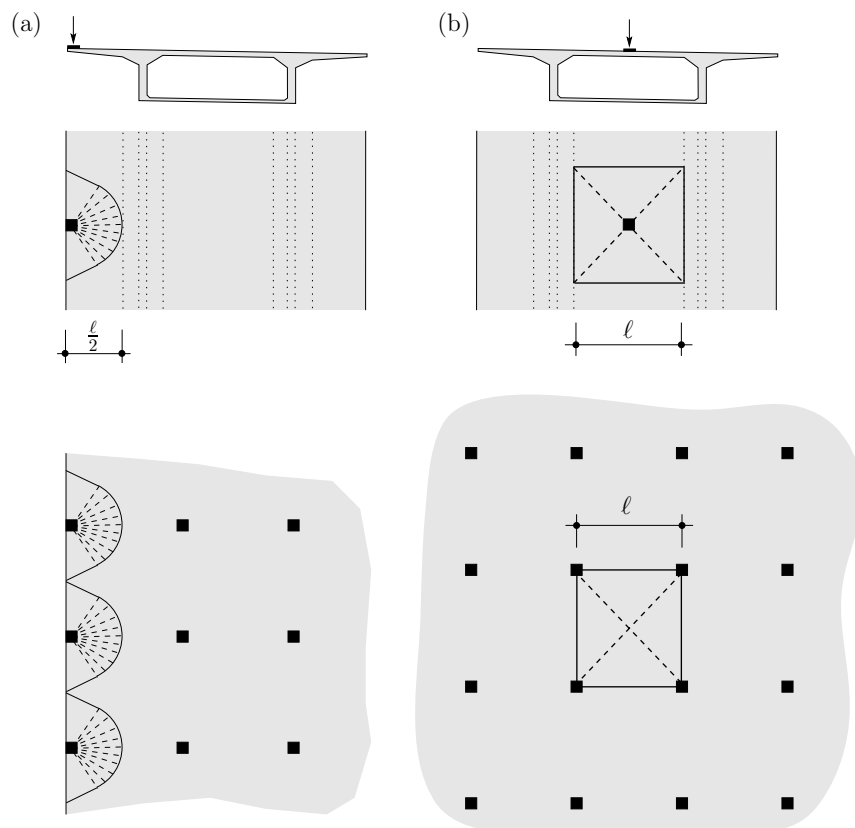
Portée équivalente pour les dalles de roulement (haut : mécanisme de flexion de la dalle de roulement, bas : mécanisme de flexion dans un plancher-dalle à trame régulière) pour : (a) porte-à-faux ; et (b) zone de dalle entre âmes.
